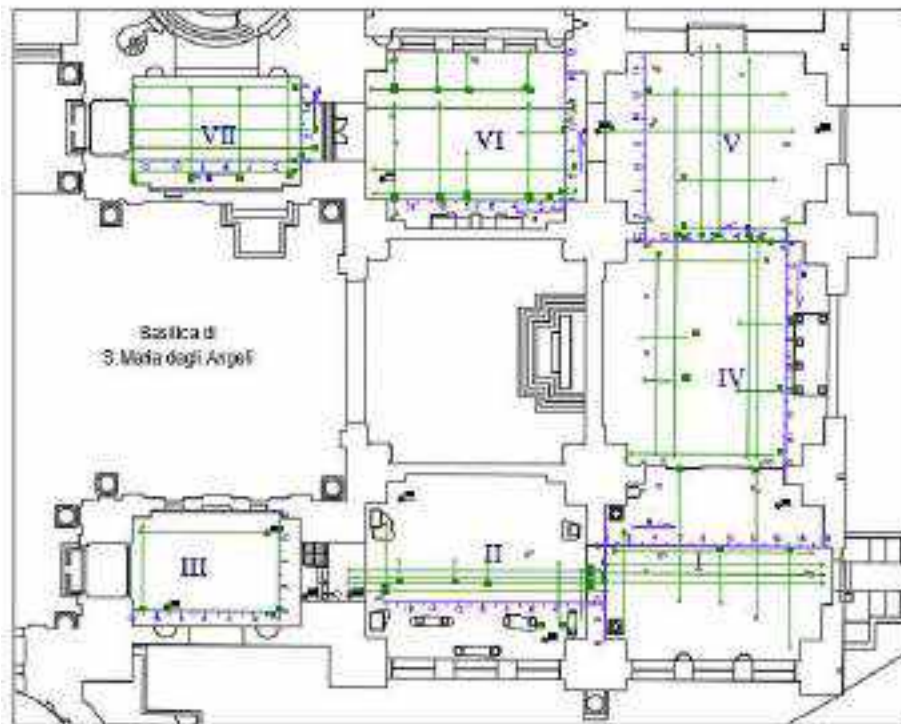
Planimetria con ubicazione all'interno delle aree di indagine delle sezioni GPR acquisite (in verde).
